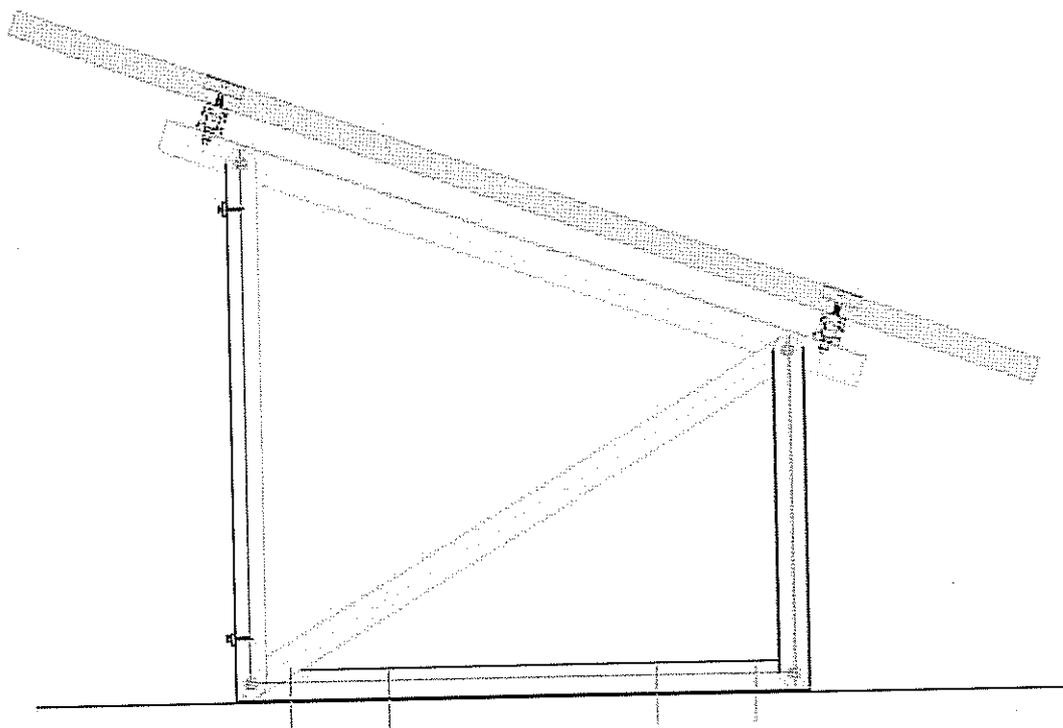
Vista laterale struttura di supporto in profili di alluminio: fissaggio diretto in copertura.
